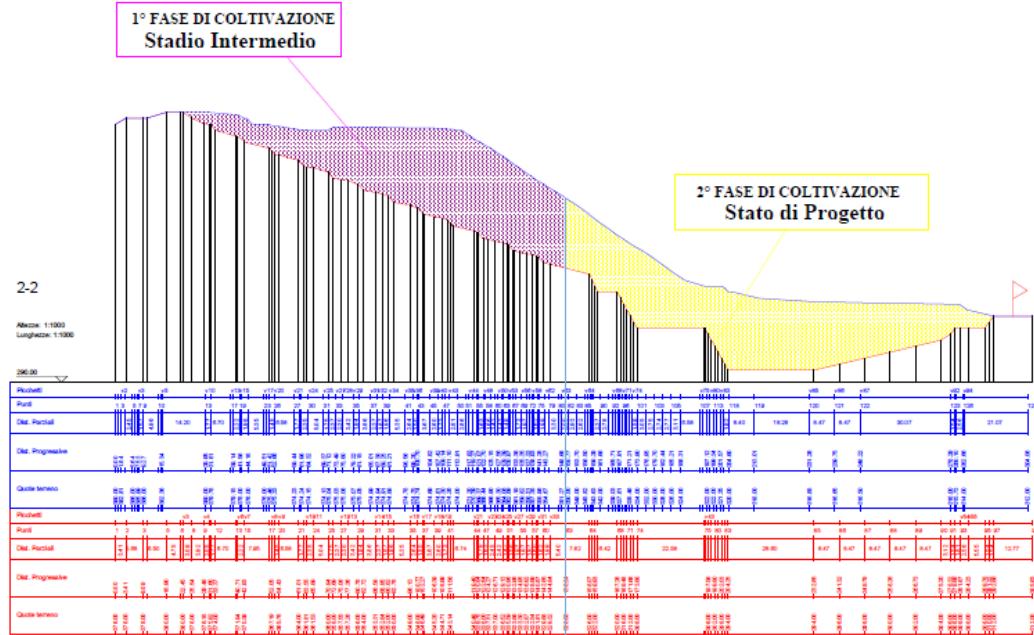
SEZIONE DI SOVRAPPOSIZIONE TIPO
